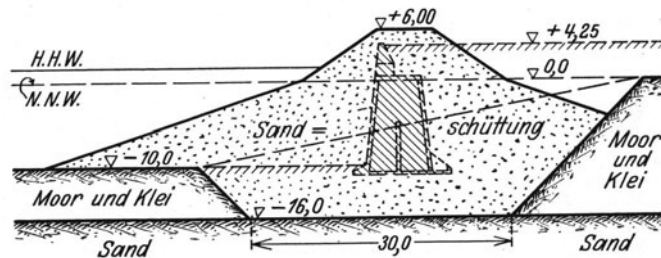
Verbesserung des Baugrundes vor der Gründung durch Belastung mit einer Sandschüttung. (Nach D. Boomsma.)
